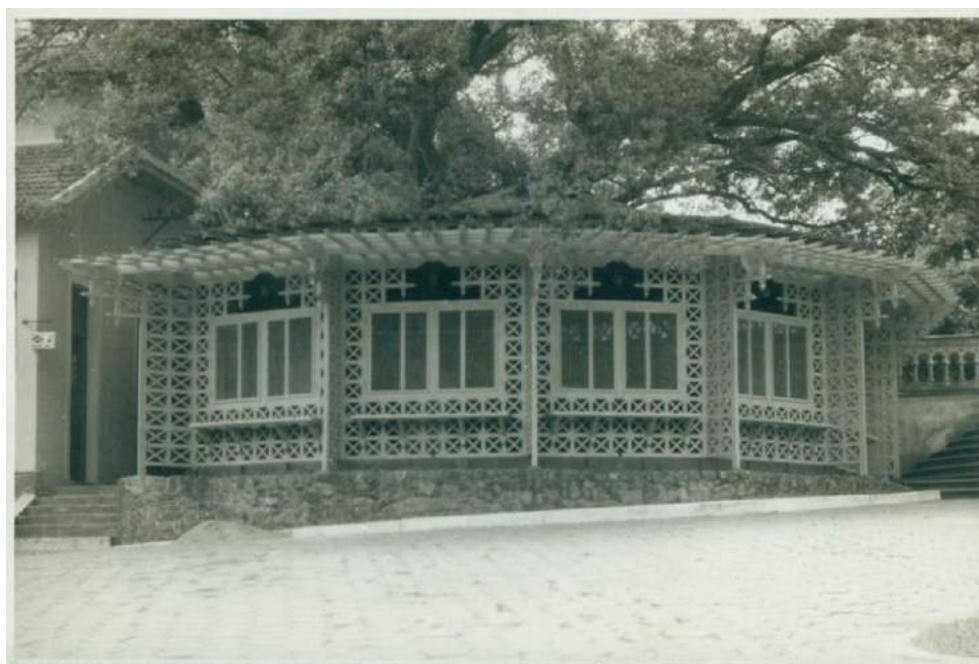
Registro do fechamento dos vãos dos painéis com janelas em madeira. Fonte: Acervo DAD/FIOCRUZ.
